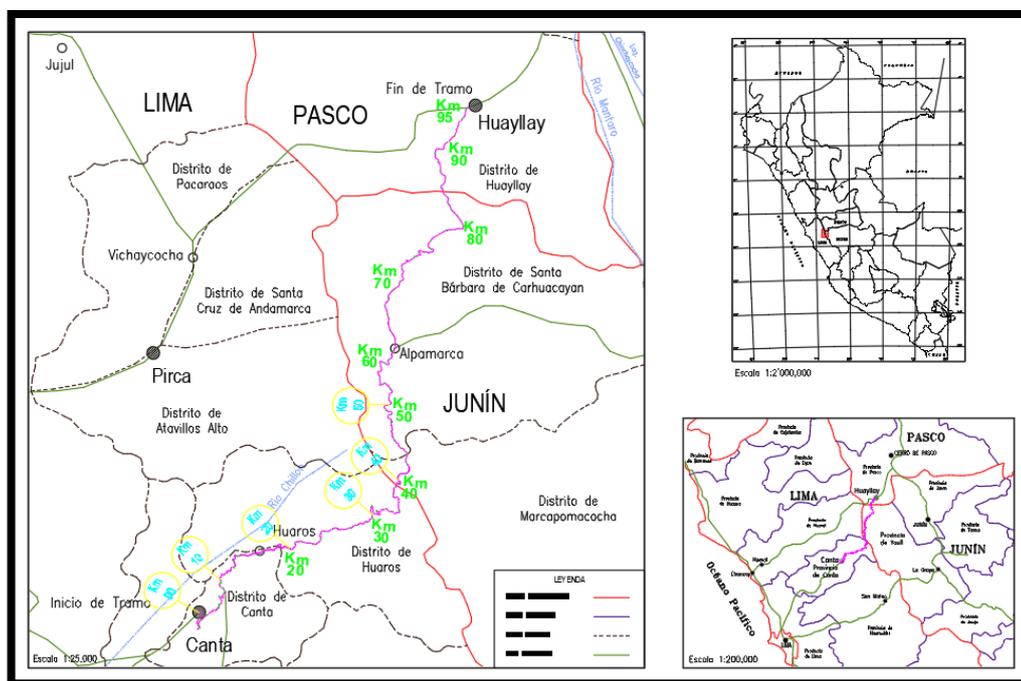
Plano de ubicación del tramo Canta – Huayllay.
